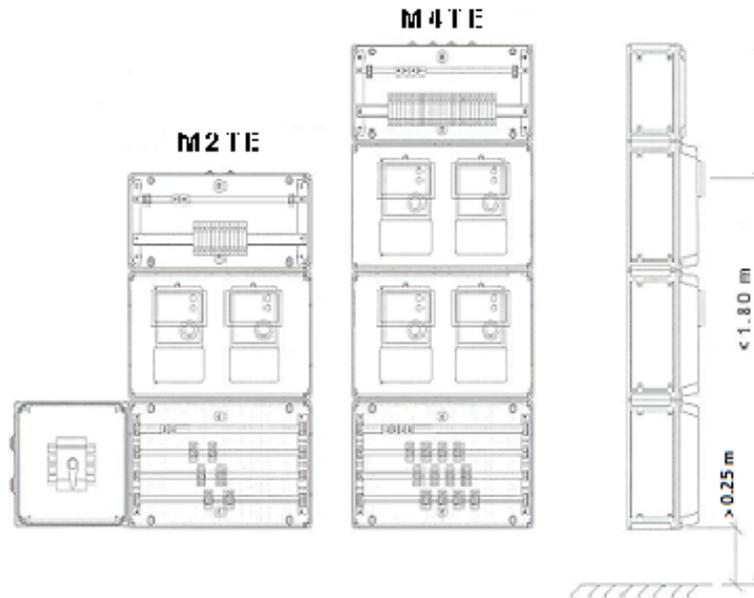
Cuadro modular tipo EM (con envolvente). Mirillas practicables TR – 16.
